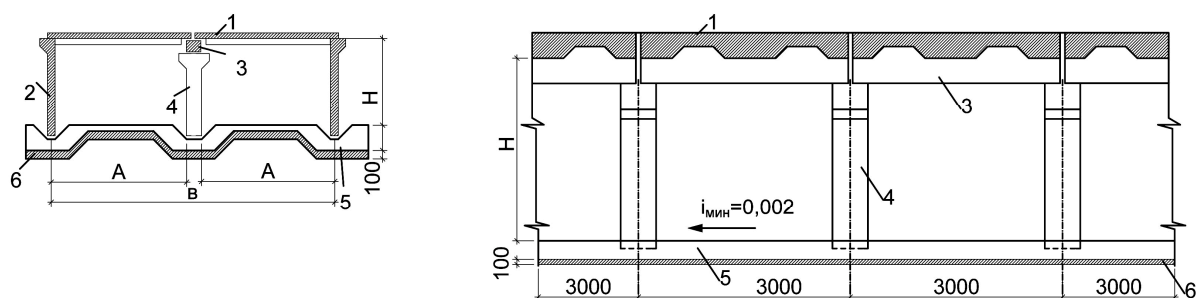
Продольный и поперечный разрезы двухсекционного тоннеля:
